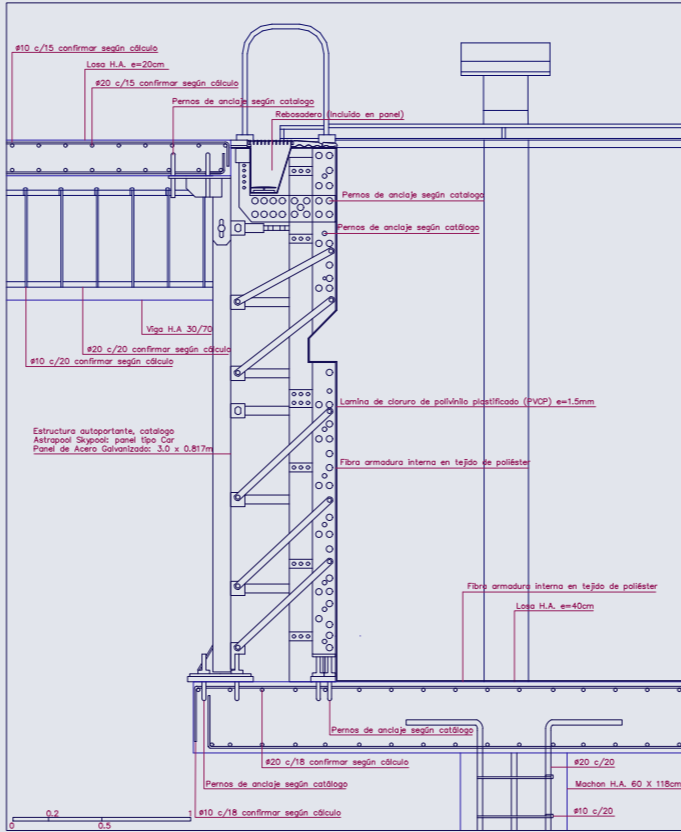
Corte Constructivo. Fuente: Elaboración propia
